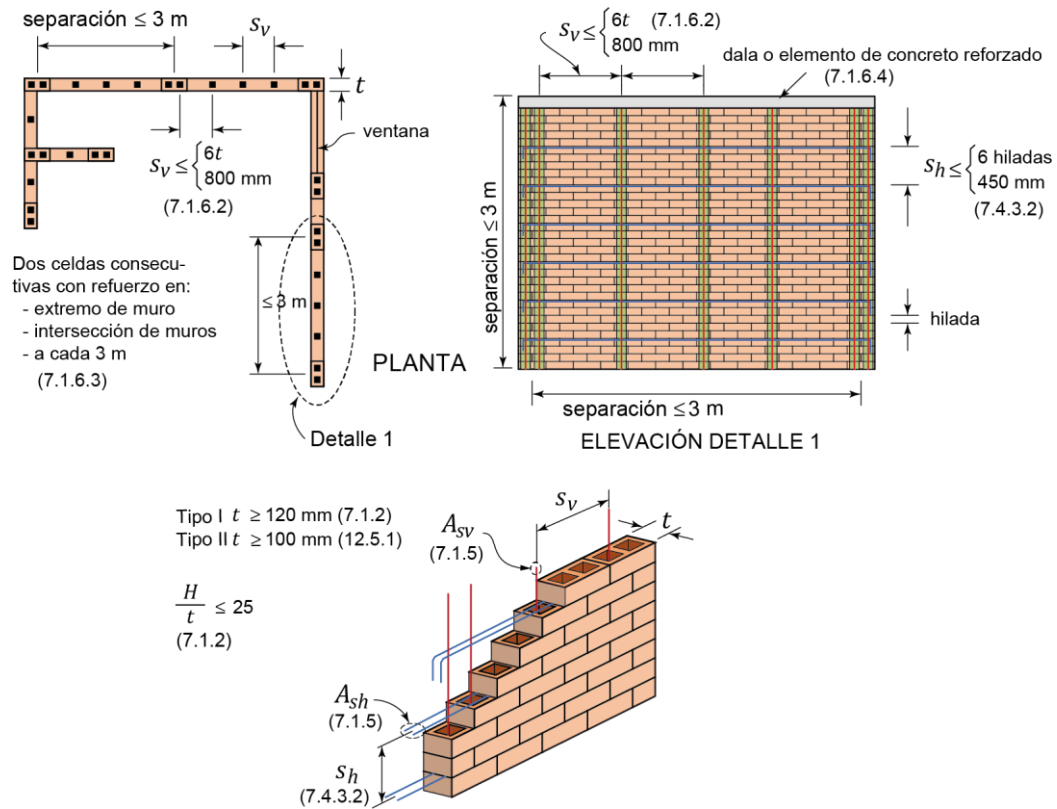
Requisitos para mampostería con refuerzo interior
